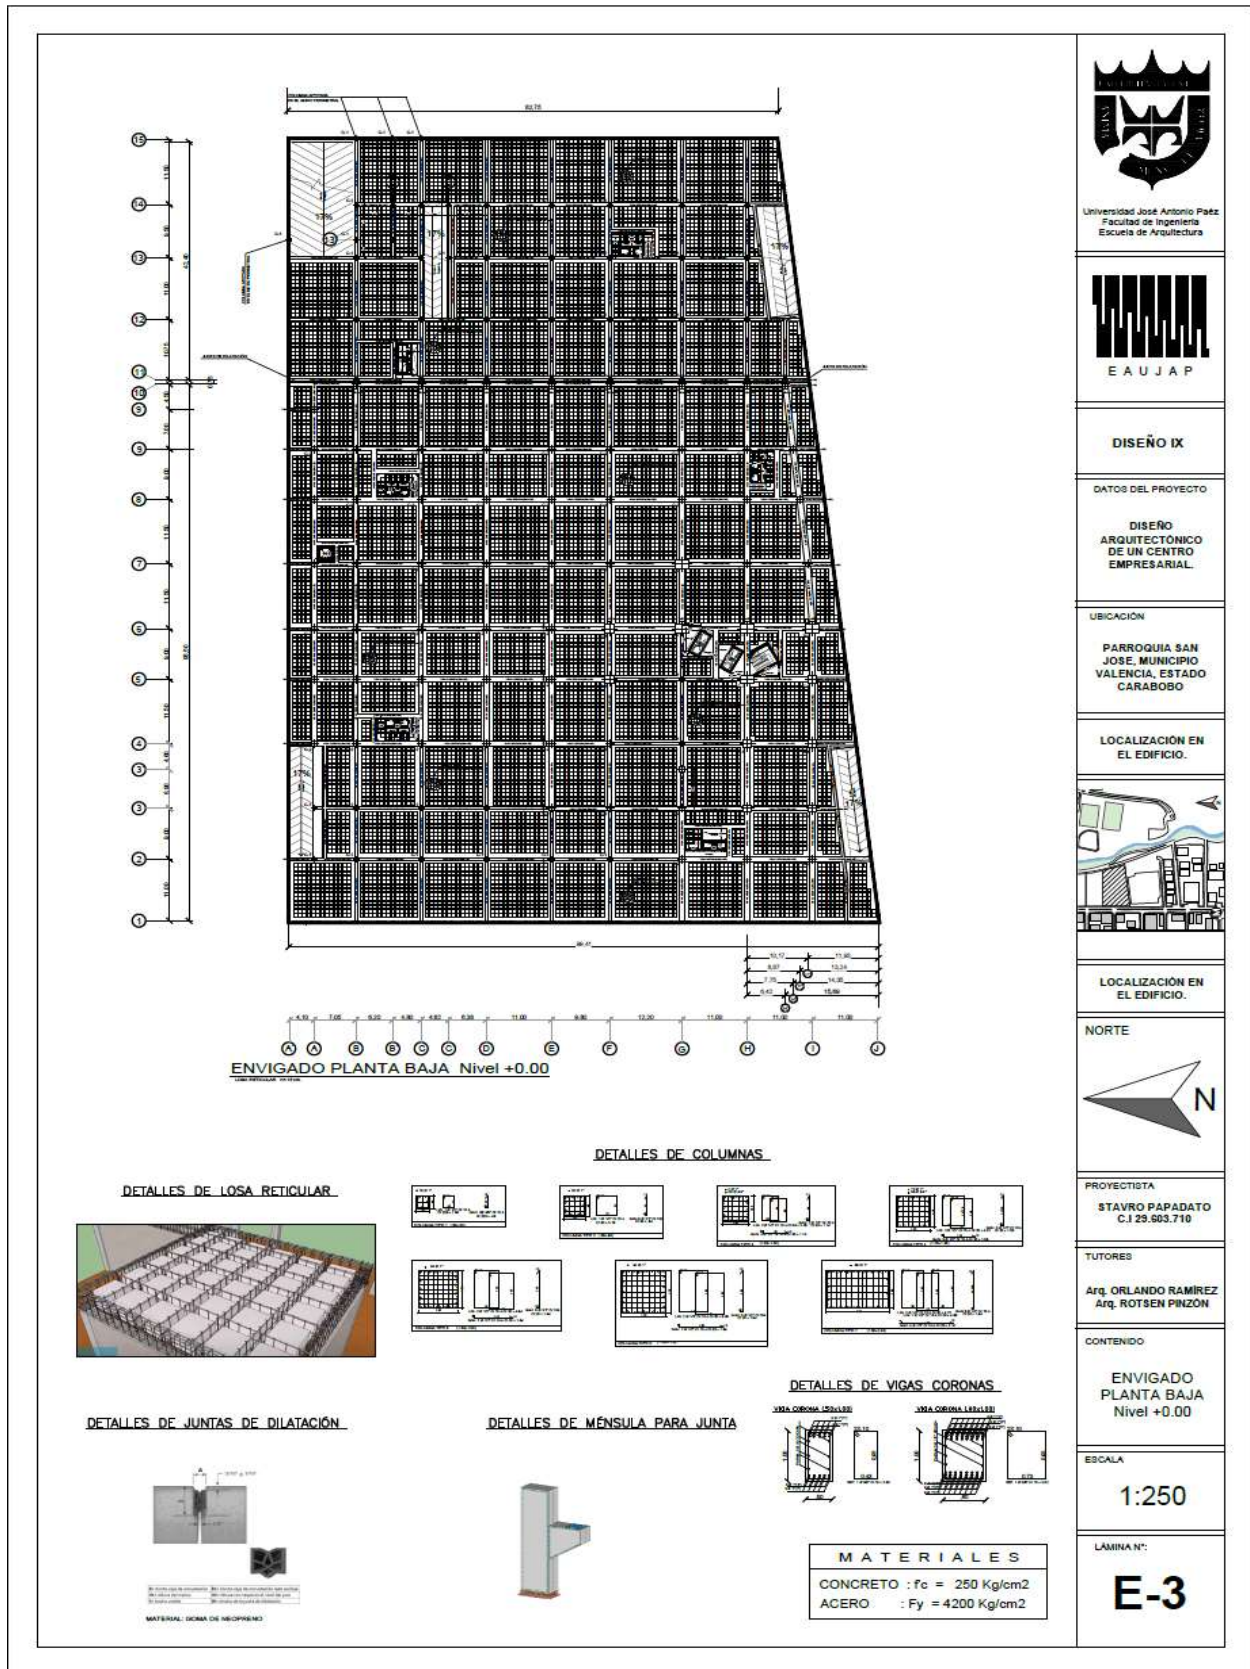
E3 Envigado Planta baja Nivel +0.00 Fuente: El Autor (2023)
